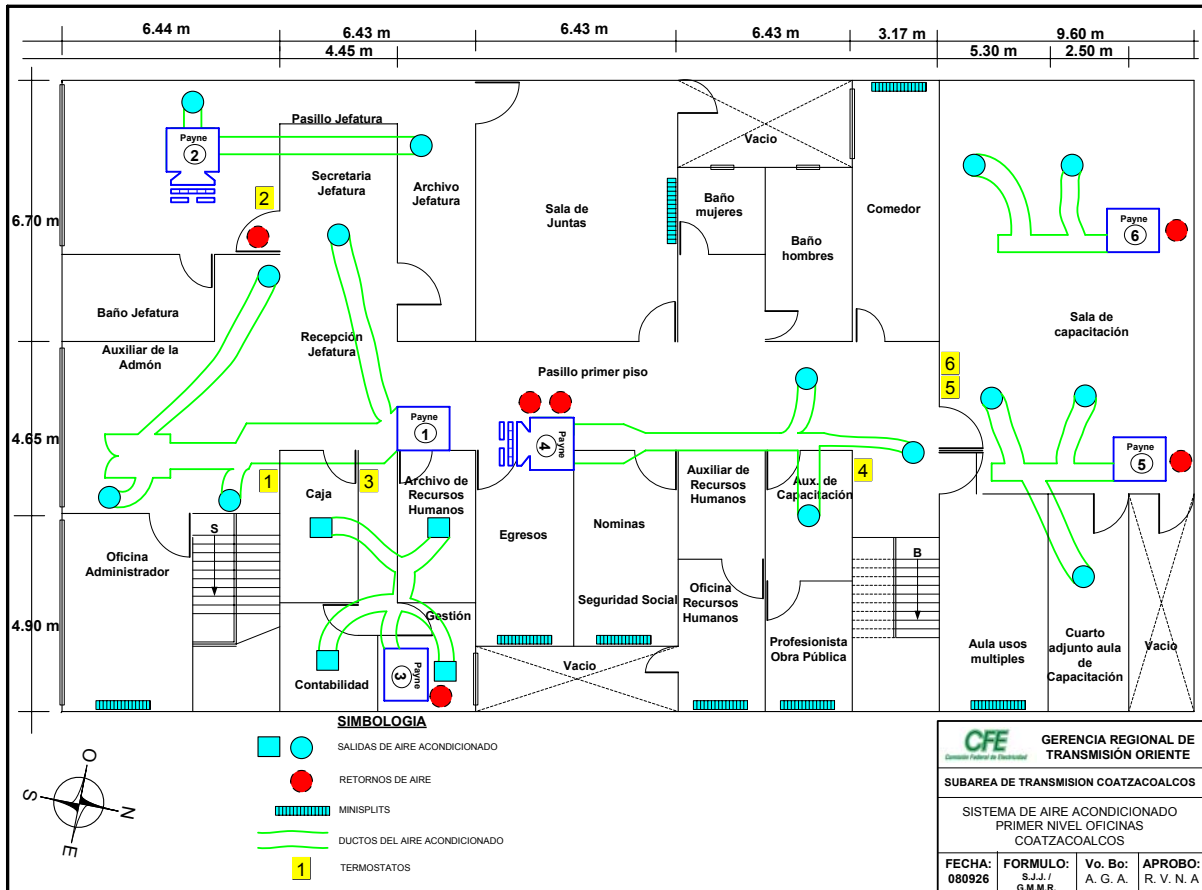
Ubicación del Sistema de Aire acondicionado en el primer piso de las Oficinas Coahuila
